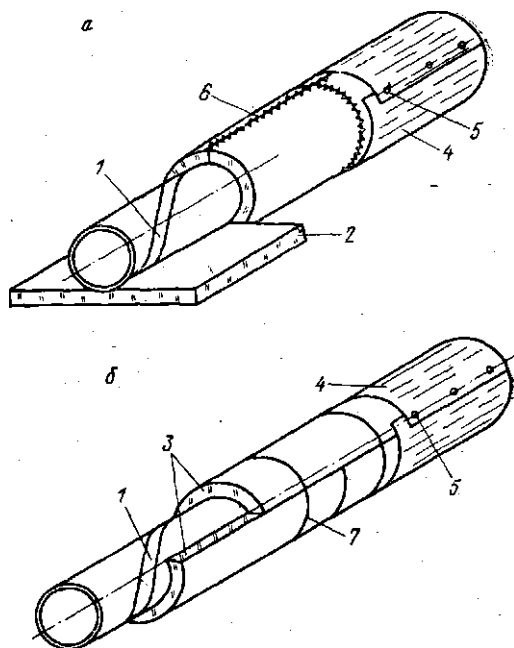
Теплоизоляционные конструкции на основе минераловатных материалов.
